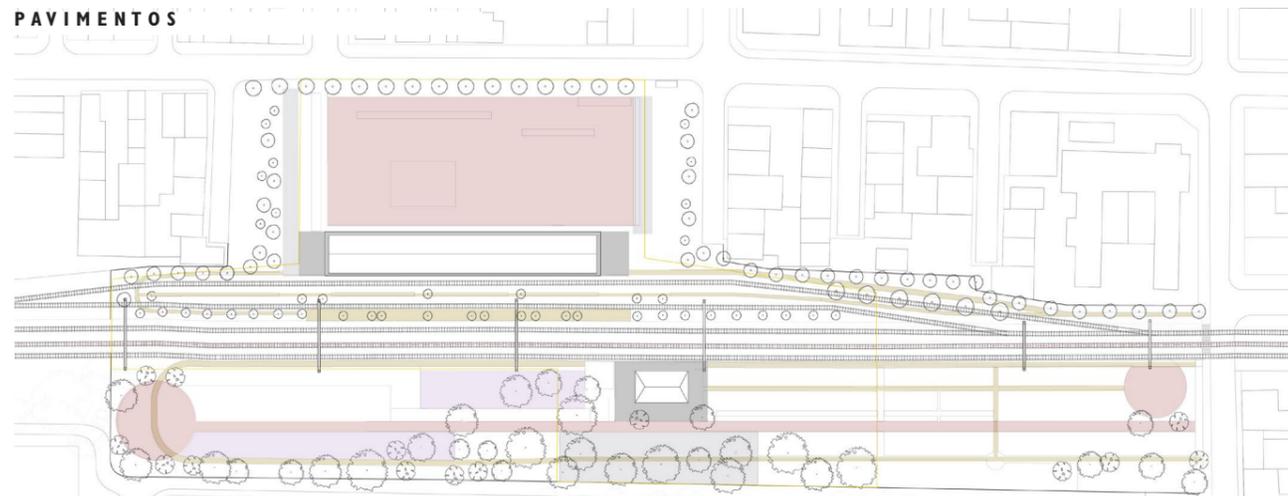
Esquemas explicativos sobre las capas que componen el Master Plan. Elaboración propia
